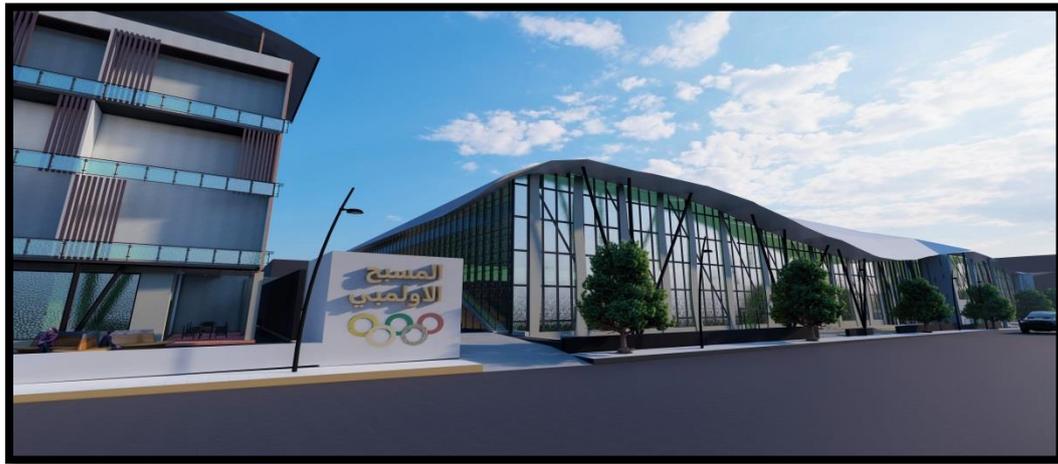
les poteaux en biais avec le mur rideaux dans la façade secondaire
